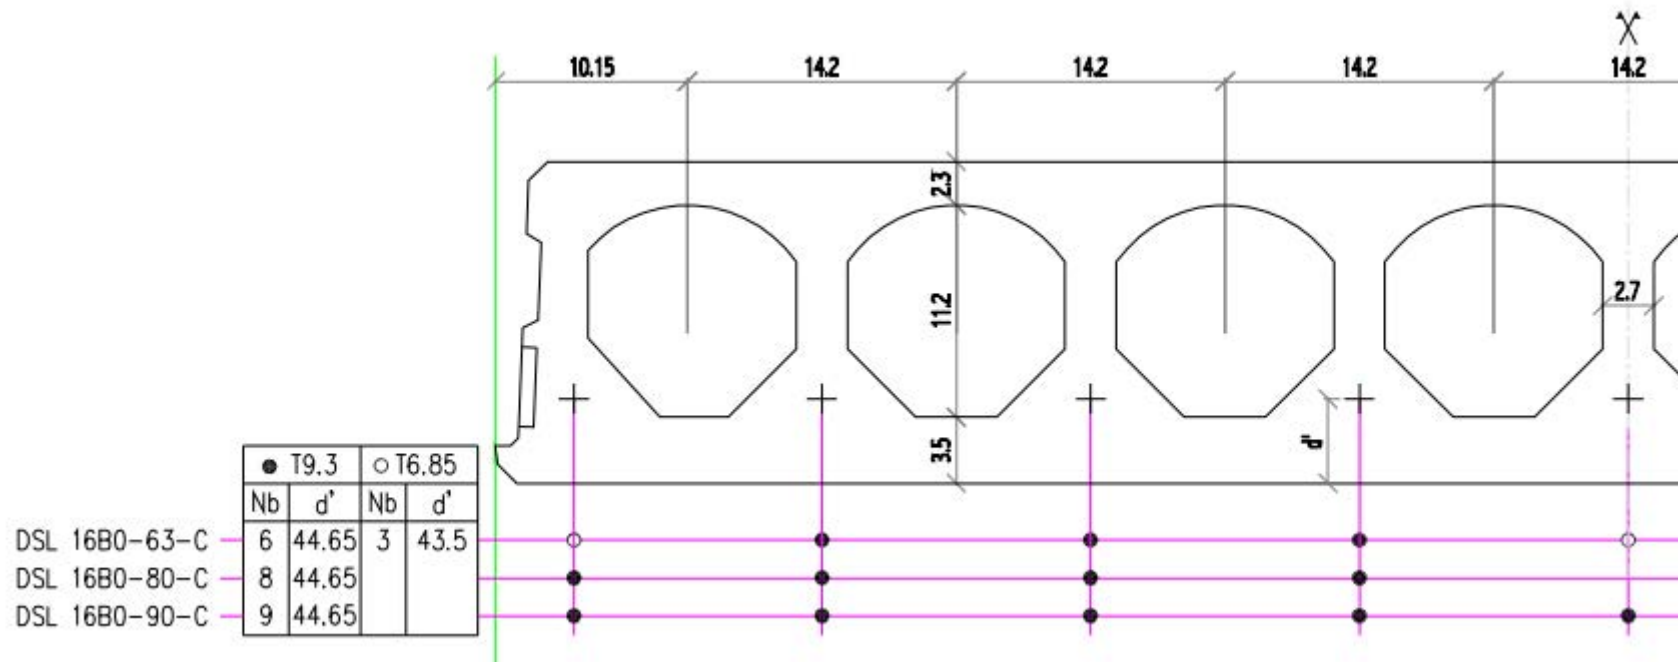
Dalle DSL 16B0 - Position des armatures de précontrainte
